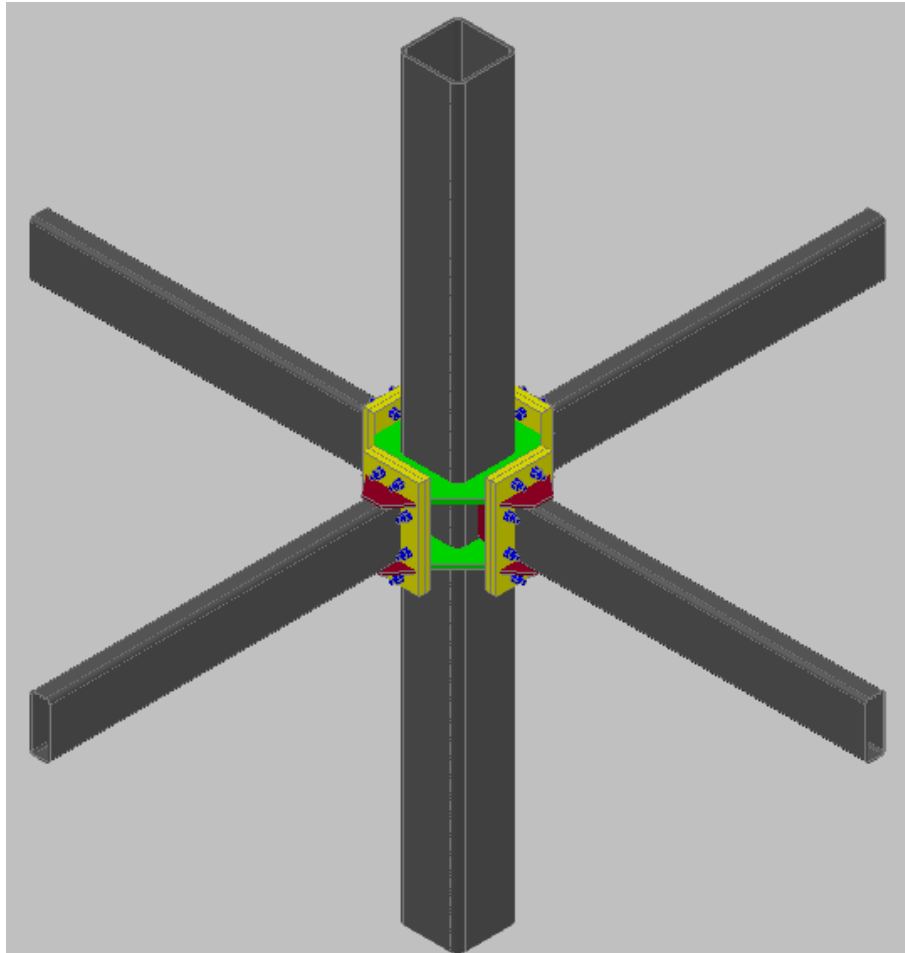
Conexión para 4 vigas rectangulares ortogonales
